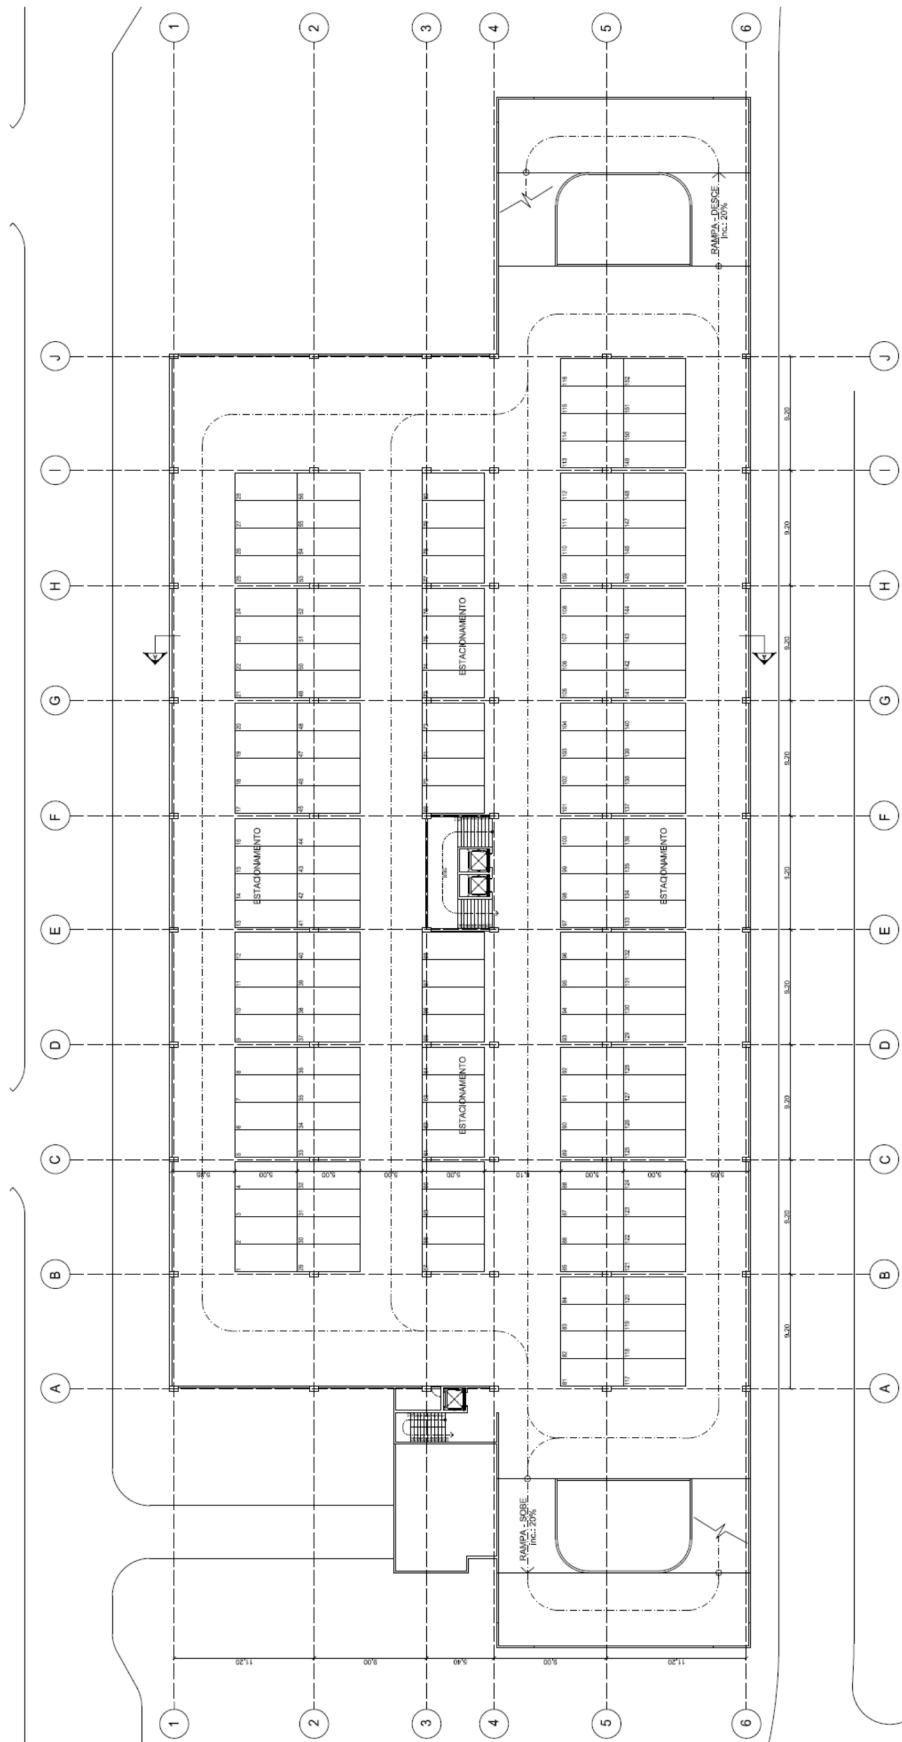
Planta baixa do pavimento térreo do edifício garagem.
